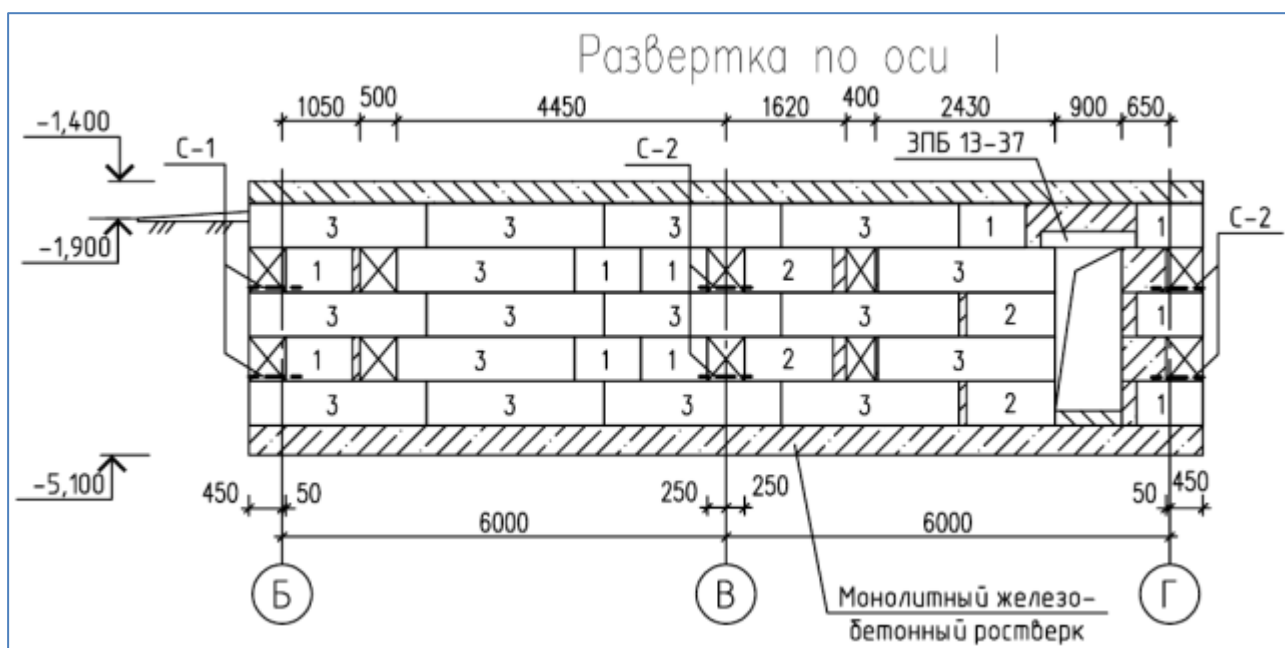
Раскладки фундаментных блоков выполненная «вручную» с использованием САПР AutoCAD.
